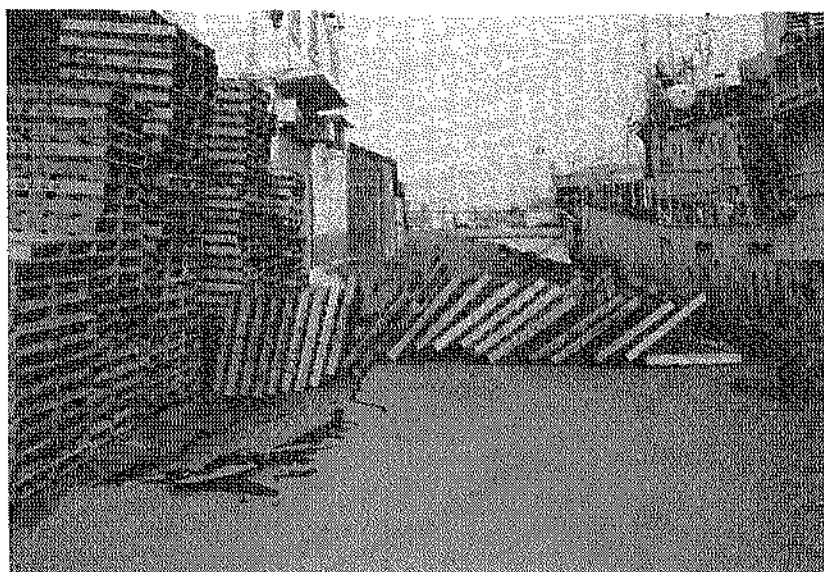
被災状況北埠頭②東岸壁 (-8.1m)
